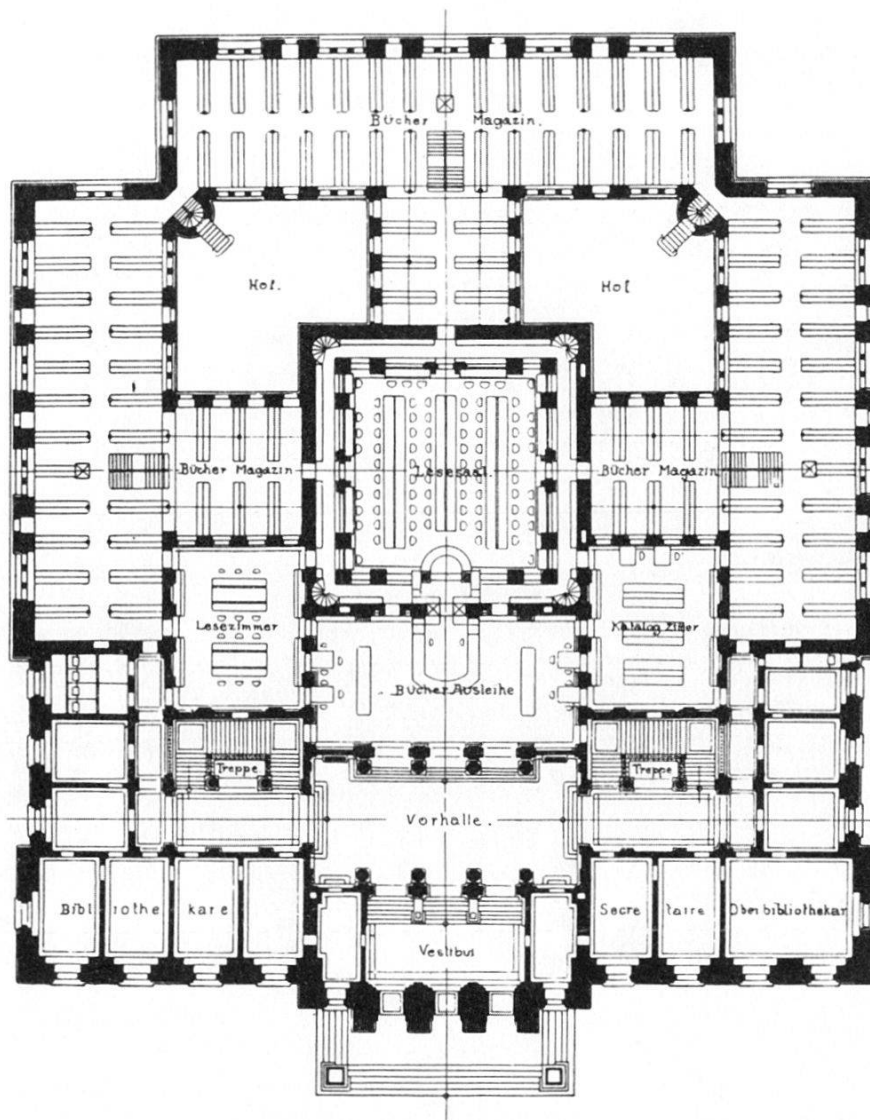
Universitäts- und Landesbibliothek Strassburg 1894, Grundriss des Erdgeschosses.
